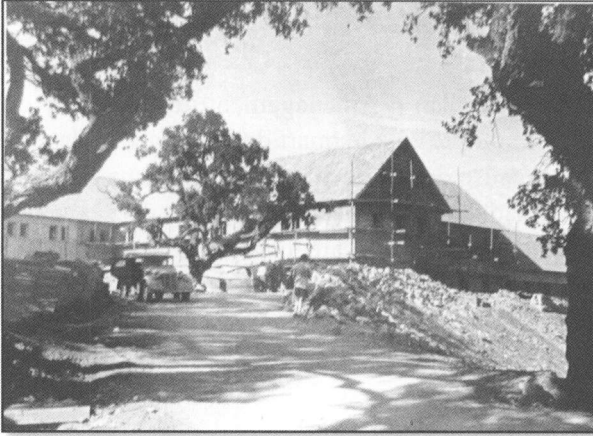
L'Hôtel des Travaux Publics en construction (photo prise le 30/9/1948). Source : Archives de la Direction Générale des Barrages.
